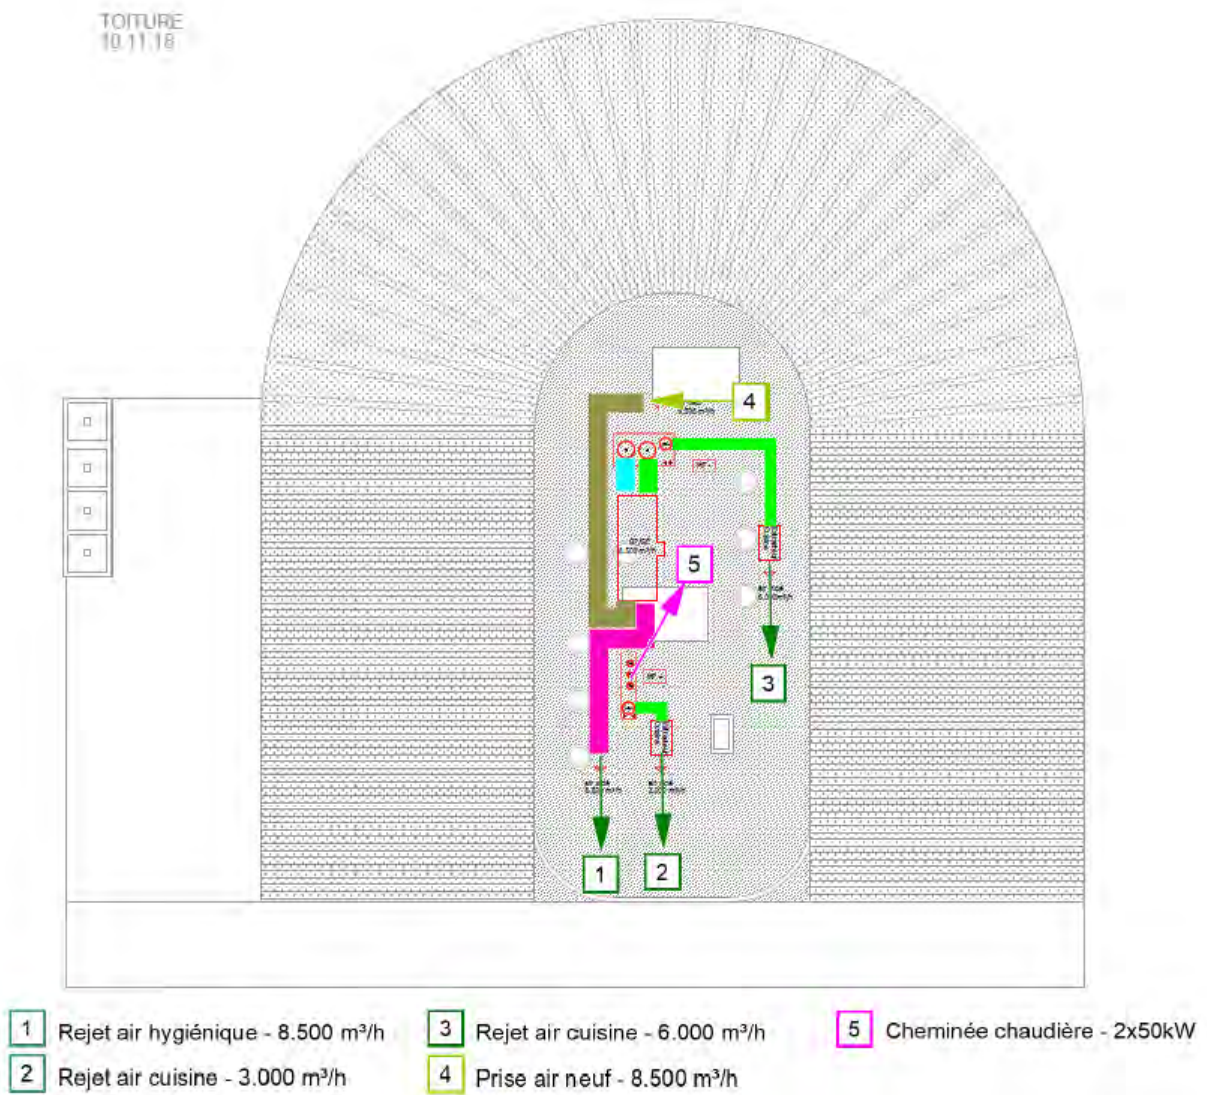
Localisation des prises d'air neuf au niveau de la façade et des rejets d'air au niveau de la toiture du restaurant (MK Engineering, 2018)
